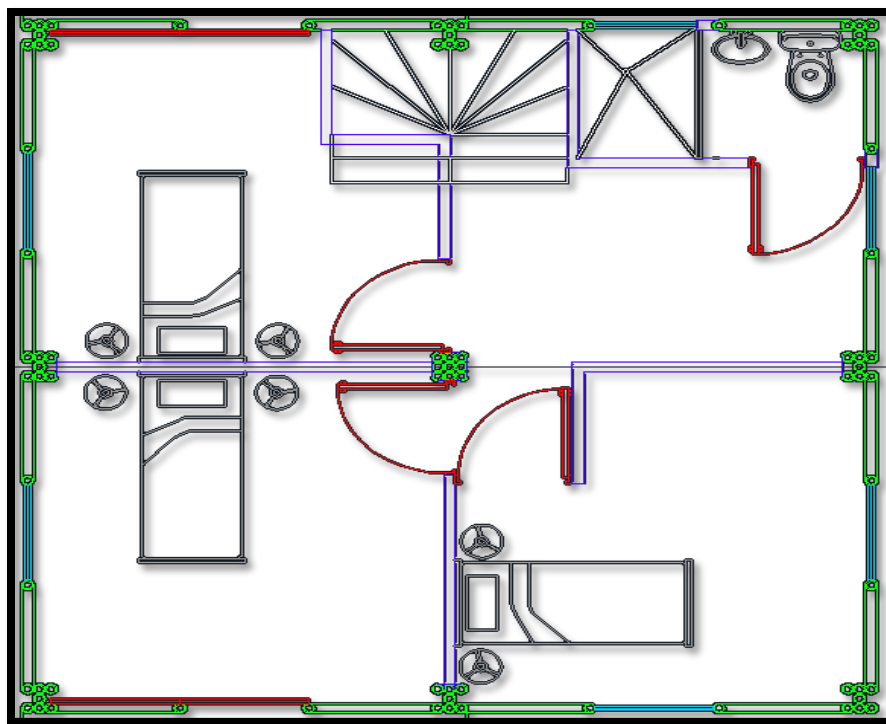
Distribución arquitectónica de la vivienda (Segunda Planta)
